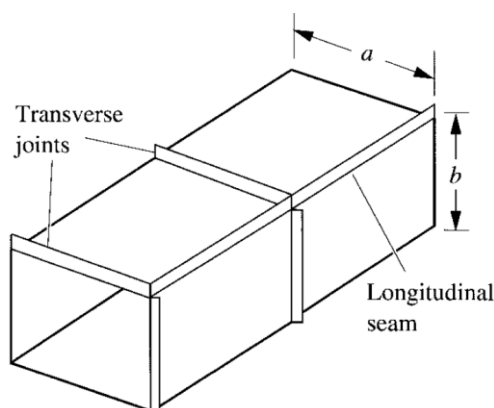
Troço de conduta de perfil retangular semelhante ao utilizado durante o ensaio experimental (Wang, 2000).
